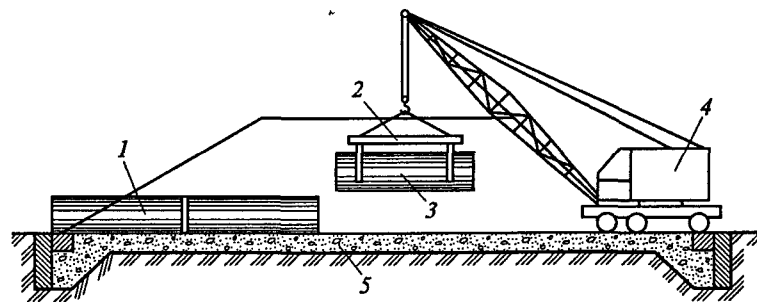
Монтаж круглой одноочковой трубы из длинномерных элементов:
